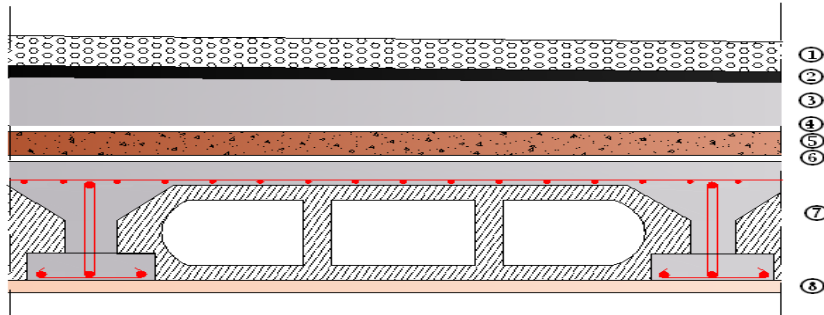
coupe transversale Plancher en corps creux de la terrasse
